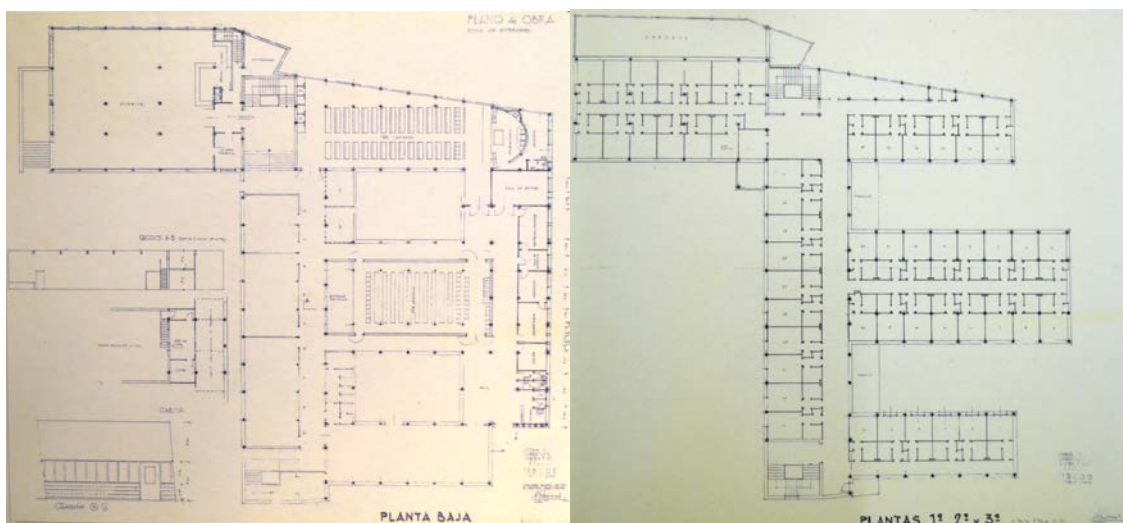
Plano de planta baja y plano de plantas primera, segunda y tercera
